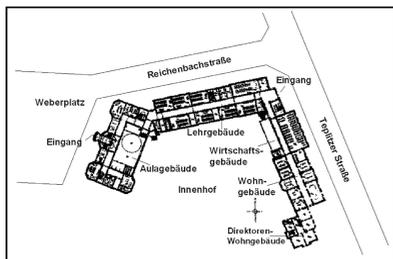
Grundriss des ursprünglichen Gebäudekomplexes
